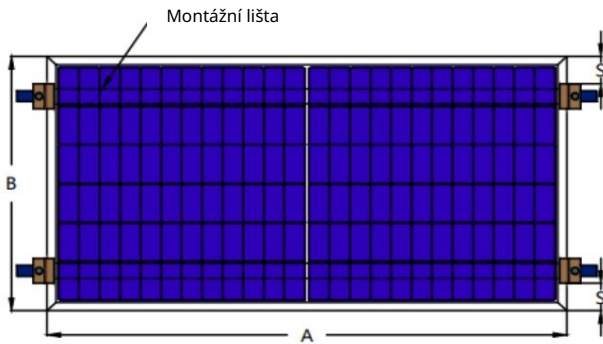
FV modul instalovaný na boku s montáží pomocí svorky
